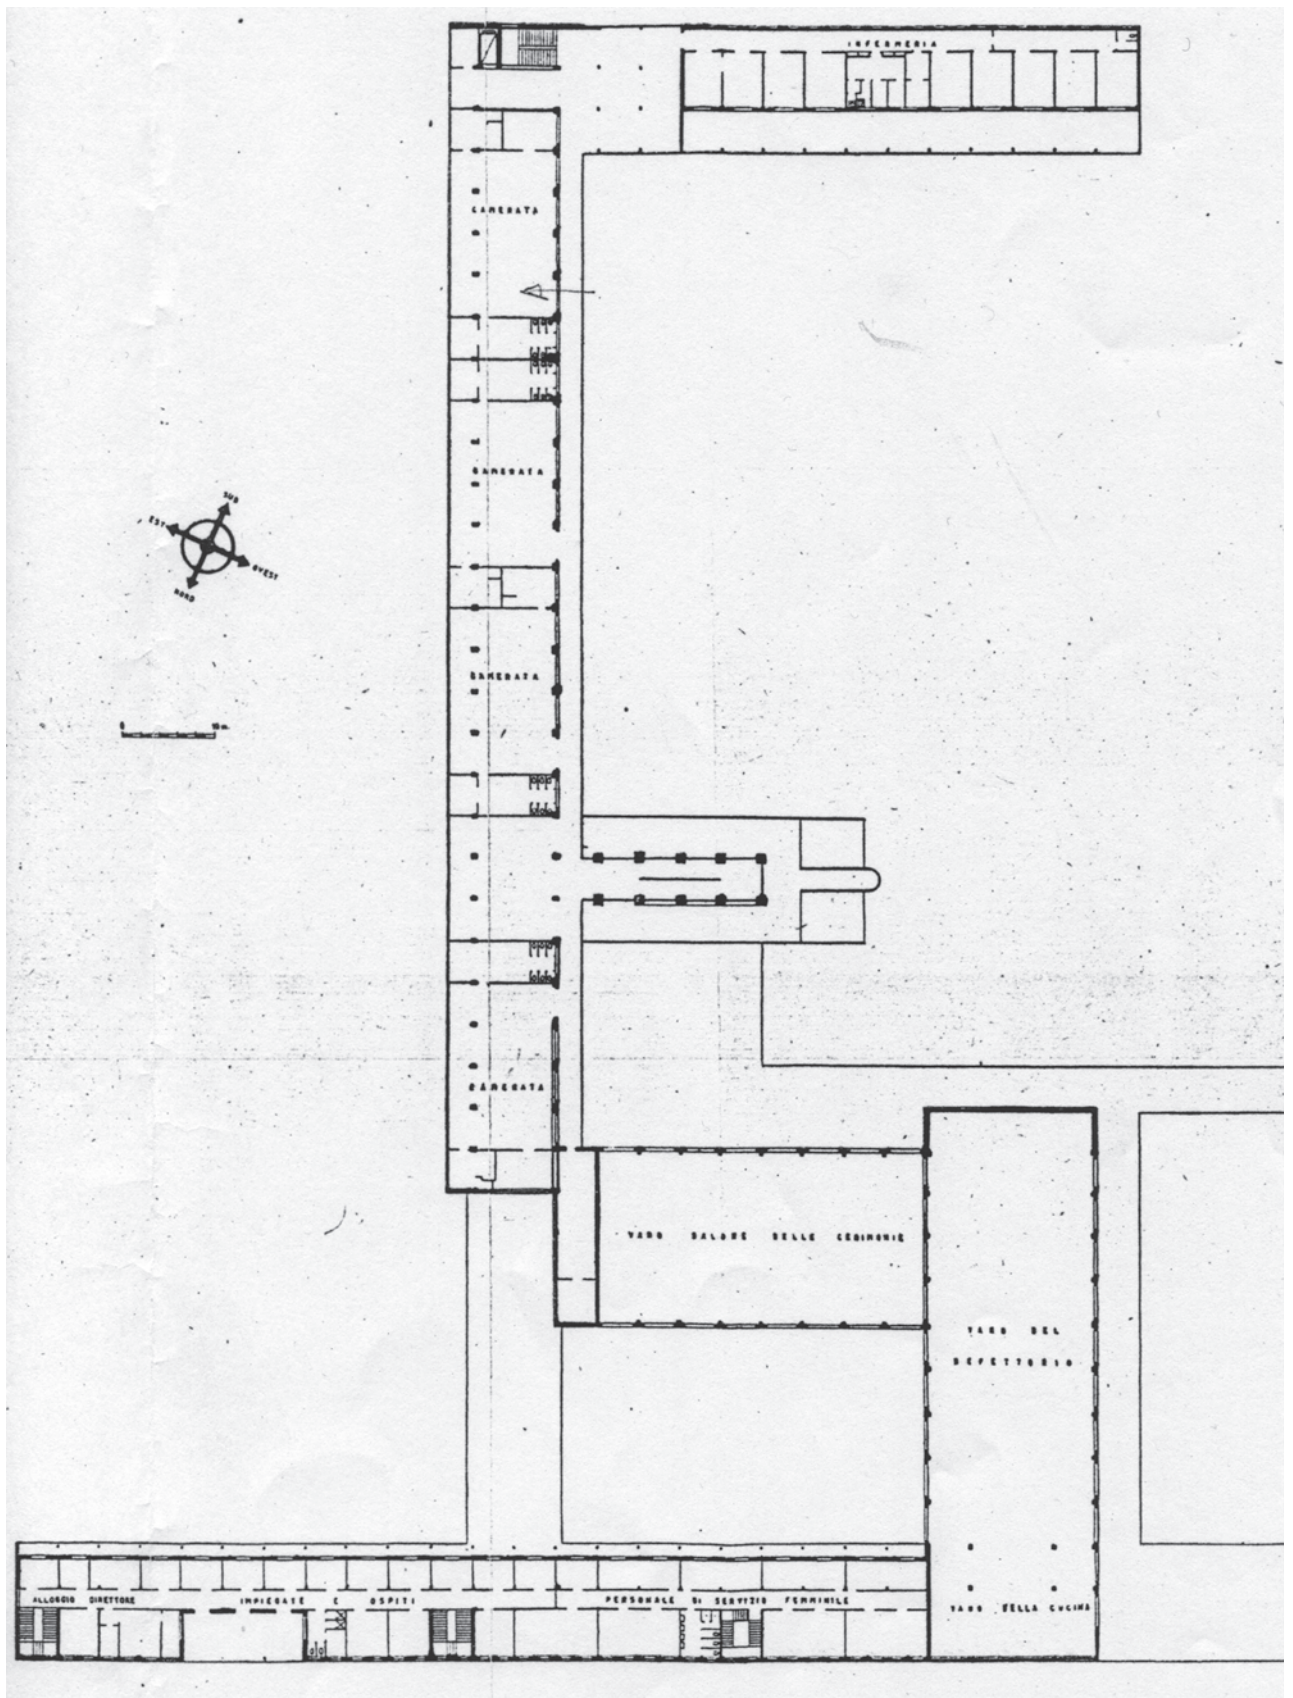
Ferienkolonie „Montecatini“: Grundriss 1.OG
